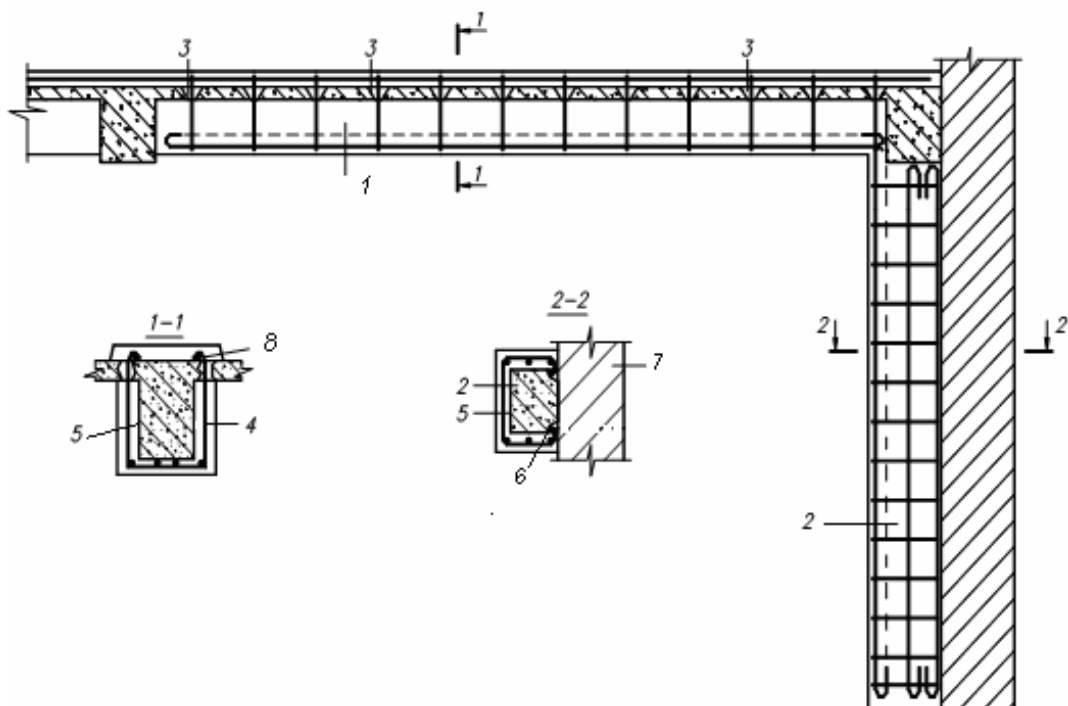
Усиление монолитной балки и колонны железобетонной рубашкой:
